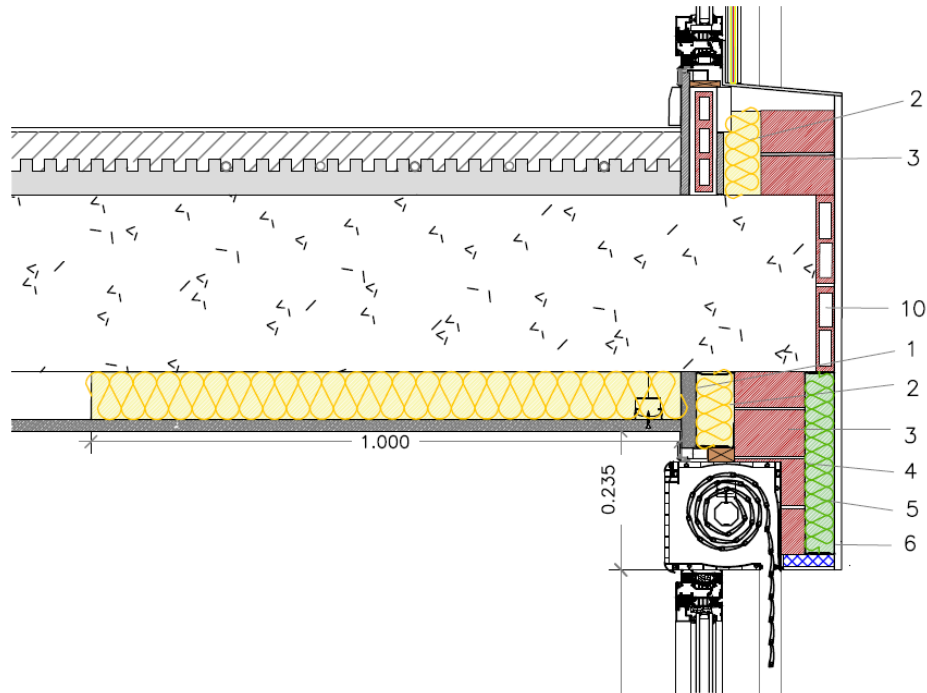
Sección constructiva, corte vertical, de la propuesta de fachada tradicional + SATE a estudio.
